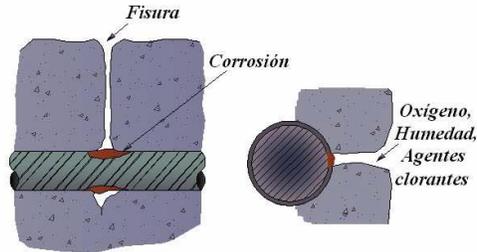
Influencia de las fisuras en la corrosión
